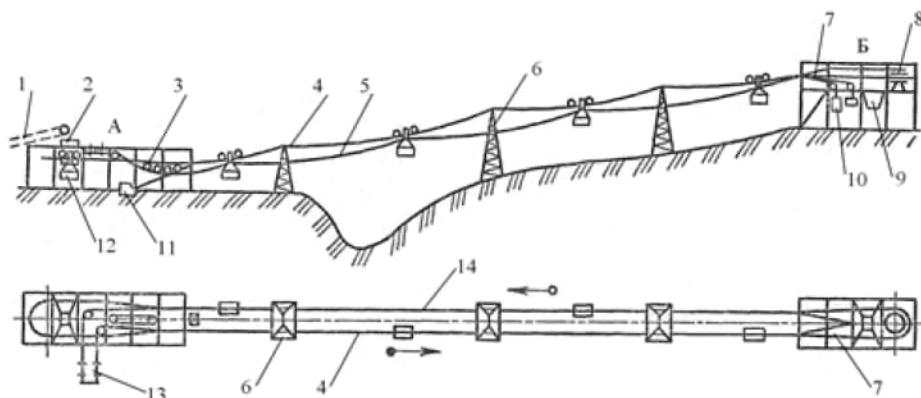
Двухканатная грузовая подвесная дорога с кольцевым движением: 1 – загрузочный конвейер; 2, 9 – бункер; 3, 7 – рельсовый путь; 4, 14 – несущие канаты; 5 – тяговый канат; 6 – опоры; 8 – оборотный шкив; 10 – грузы натяжного устройства; 11 – закрепляющие якоря; 12 – вагонетки; 13 – трекционный привод
